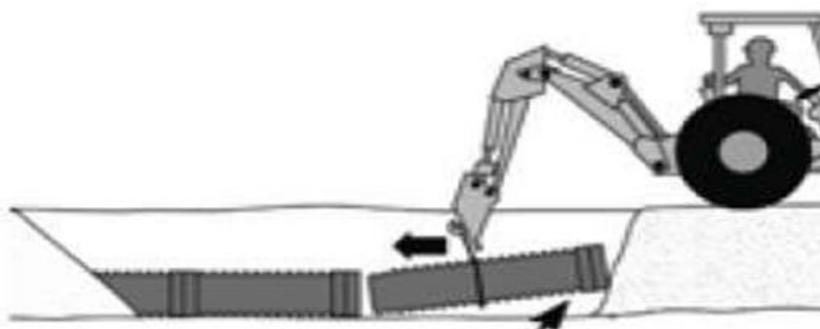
Instalação de Tubo PEAD Utilizando Escavadeira.
